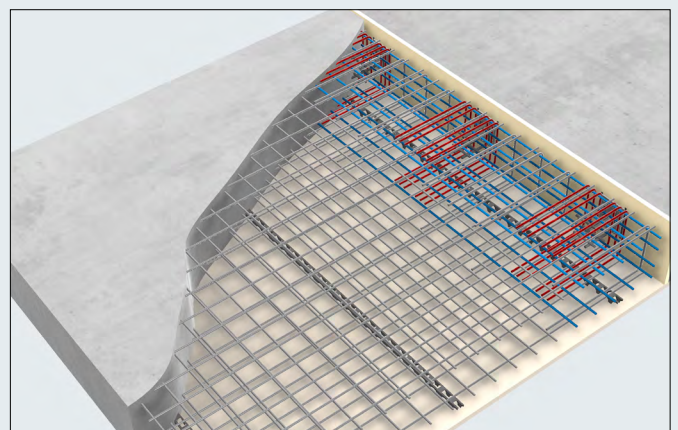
Zusätzliche Bewehrung verlegen und nach Bewehrungskontrolle Platte betonieren.
